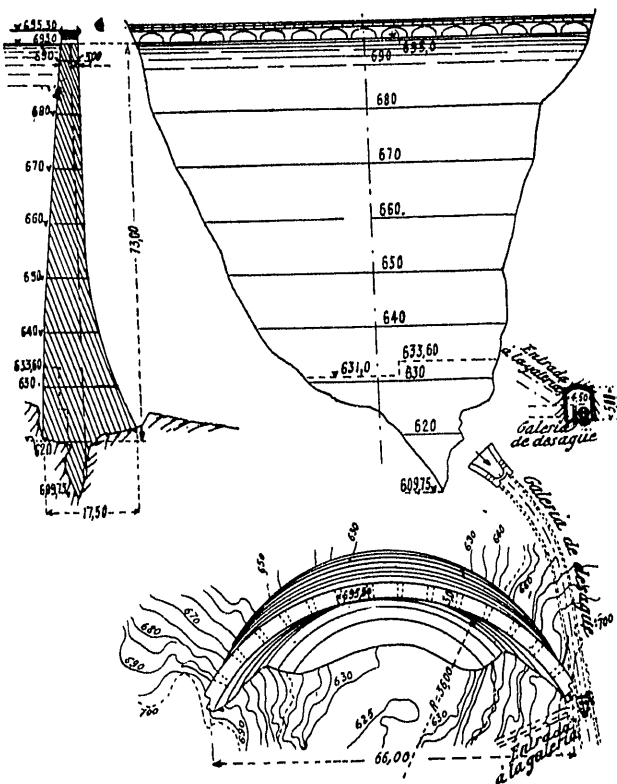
^a Planta, alzado y corte de la presa de Montejaque.
